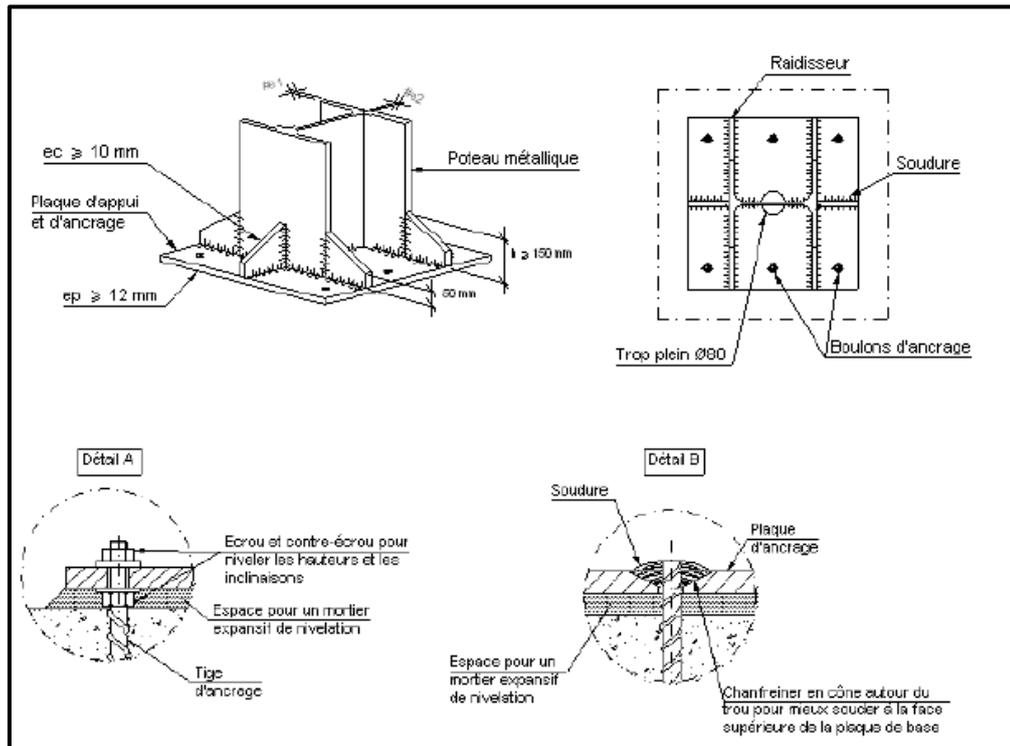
Détails technique de l'encastrement d'un poteau métallique.
